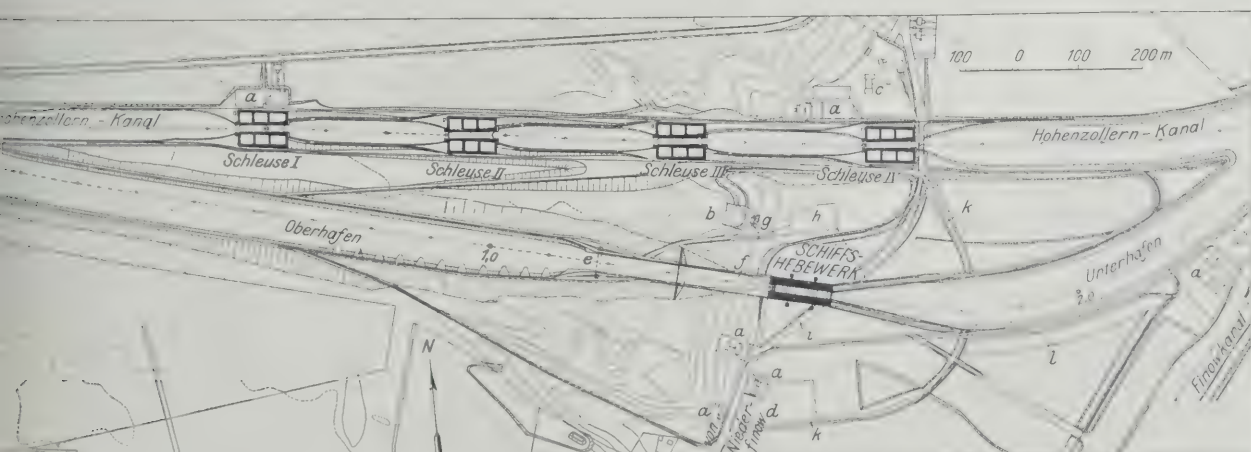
Lageplan der Schleusentreppe und des geplanten Schiffshebewerks bei Niederfinow
